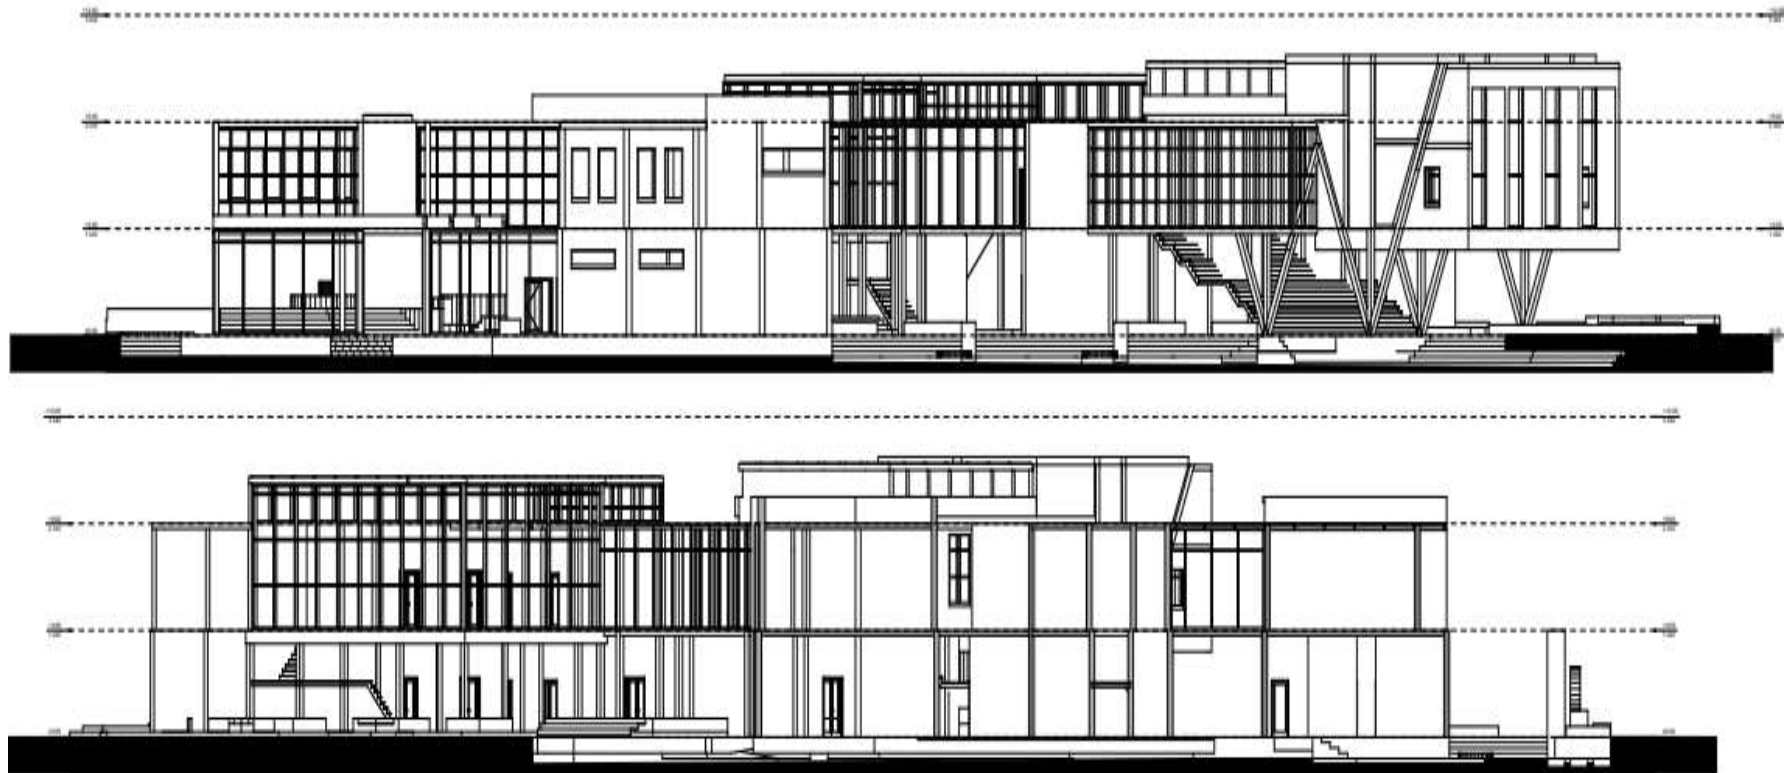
Segunda Vista - Cortes Generales del Proyecto de Centro Cívico.
